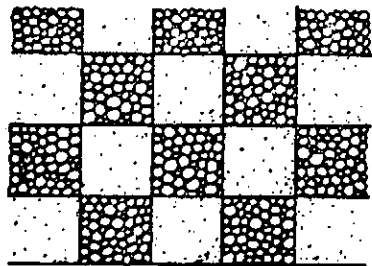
LOSAS DE PIEDRA ALTERNADA
